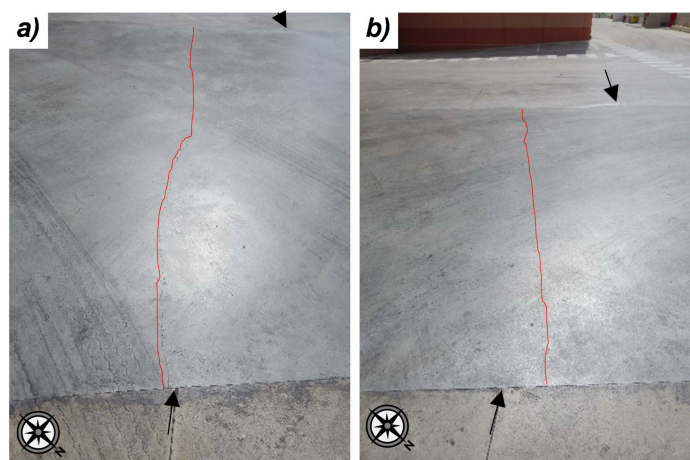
53 – Fisuración observada y localización de las juntas adyacentes
